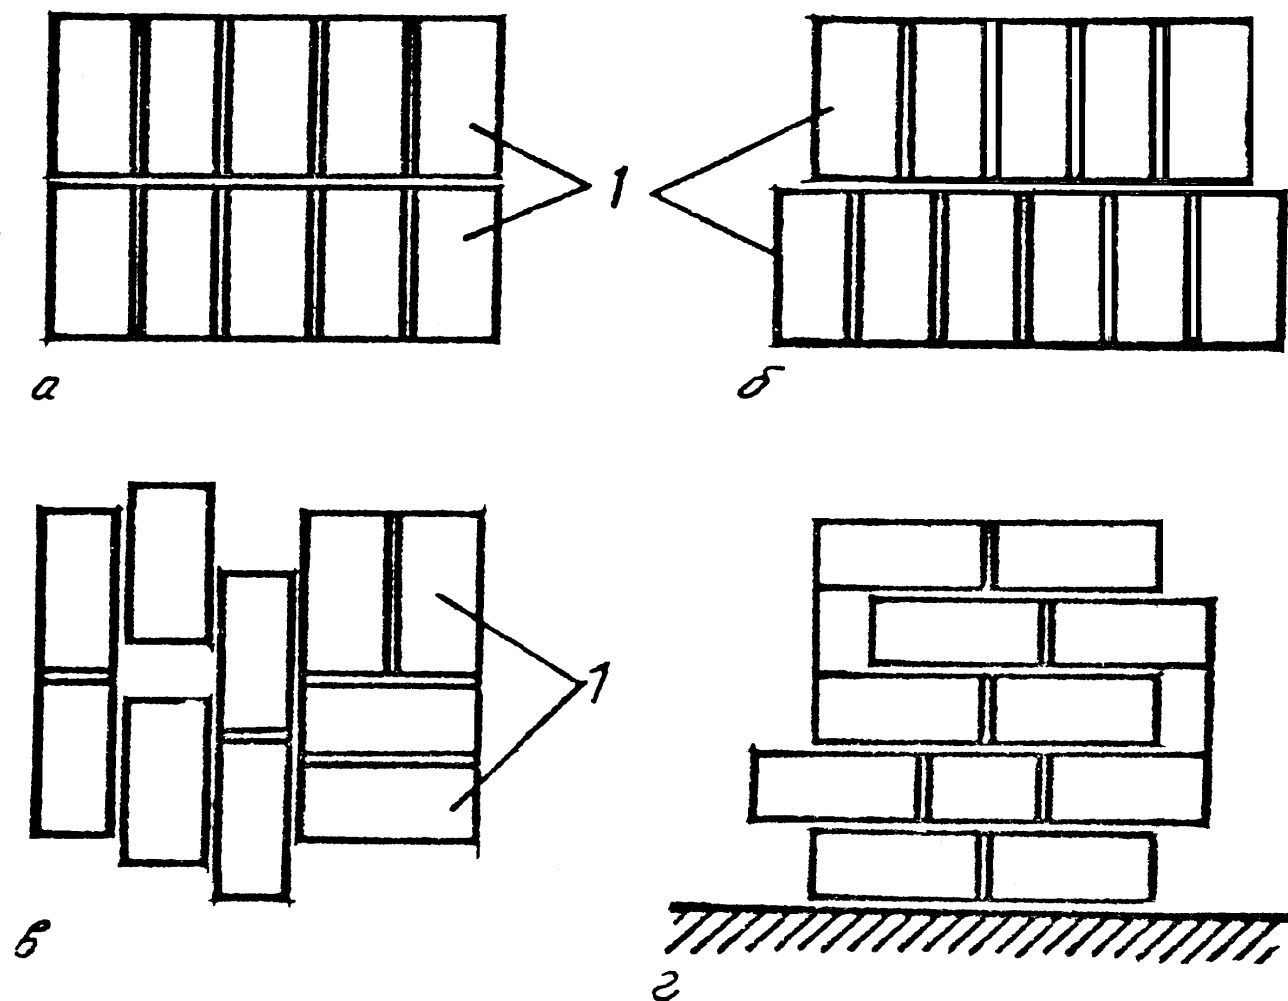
Схеми будівель з об'ємних блоків:
